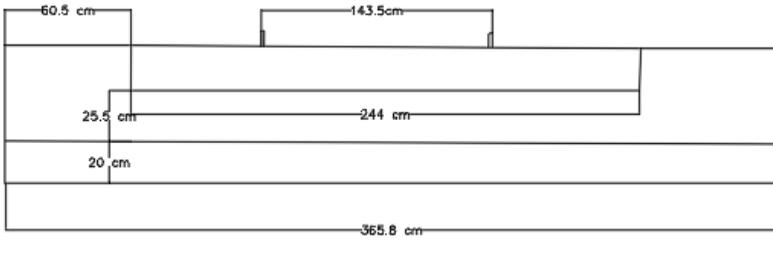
47 Penampang Melintang Lebar Jalan Rel 1435 mm
